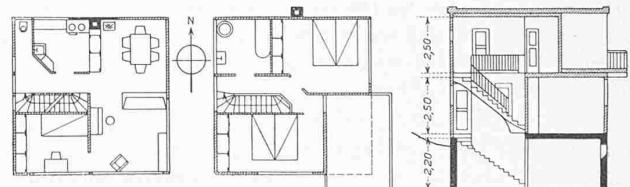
bis 7. Entwurf von Walter Wirth. — Risse 1 : 300. — Schwarz bedeutet in sämtlichen Zeichnungen Mauerwerk, schraffiert ist Holz.
